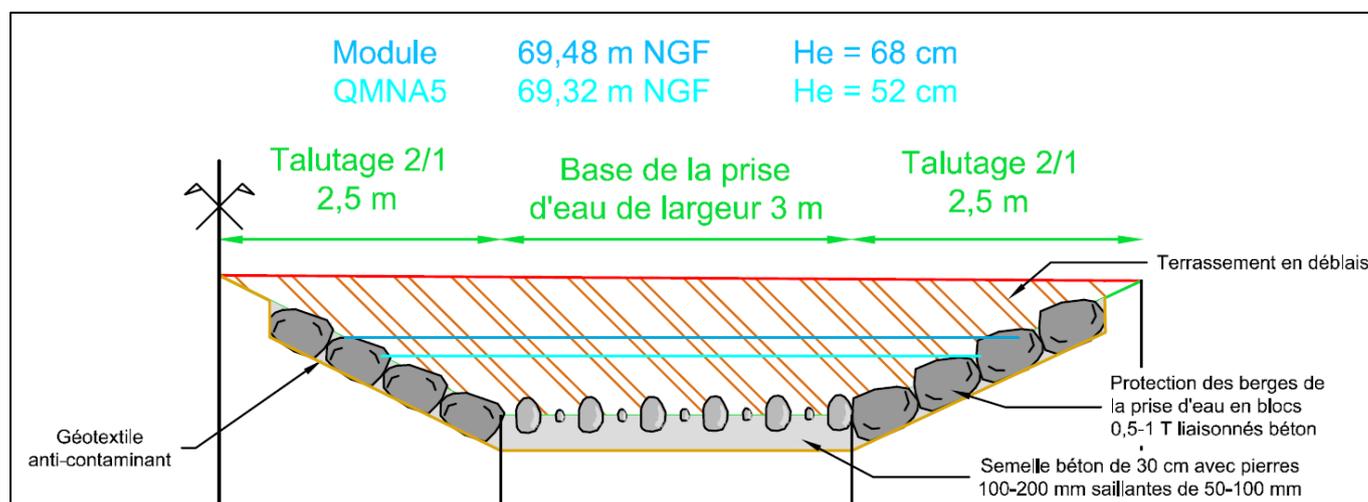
Profil en travers au droit de la prise d'eau du nouveau lit (PT1)
